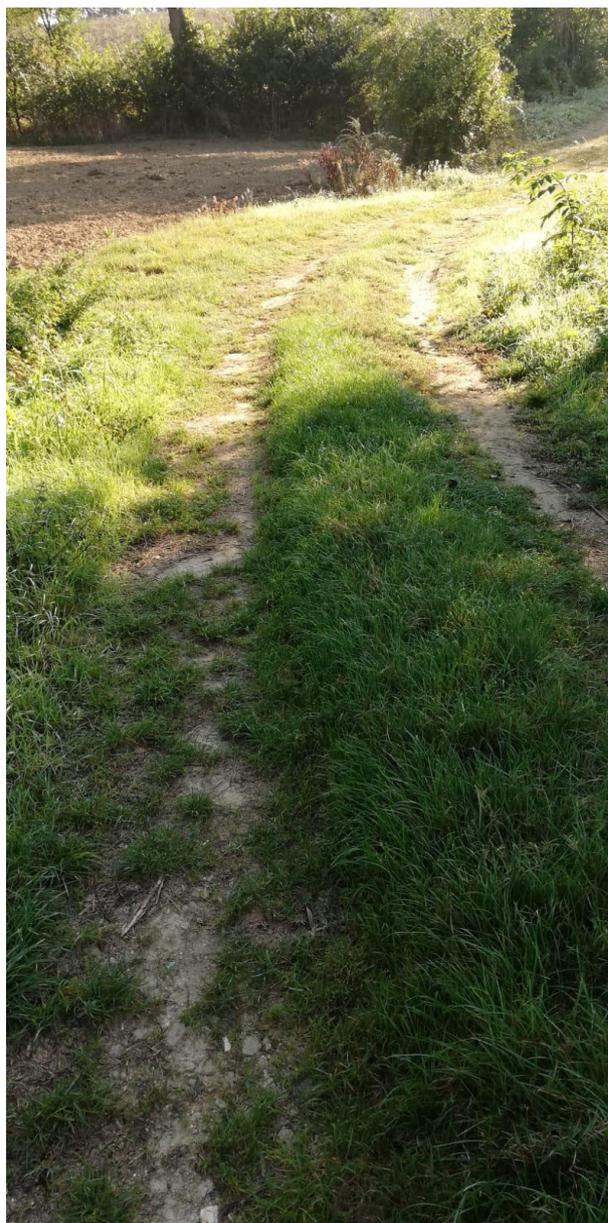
Zona compresa fra Picchetto n.26 e n.25 – Zona attraversamento Rio Maggio e Fosso delle Fontanelle
